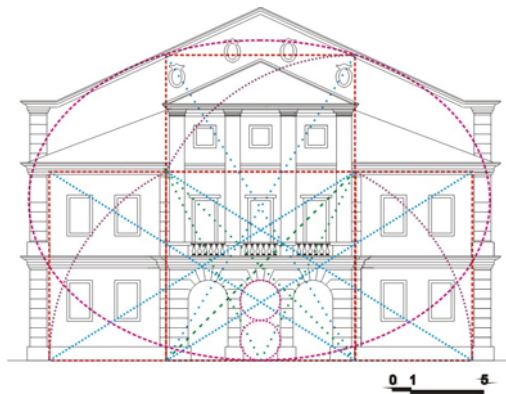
Traçado regulador da fachada em analogia com a planta baixa do Teatro, denotando total integração entre planta e elevação.
